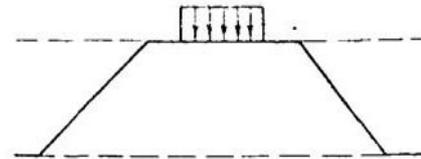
Расчет напряжений в грунтах насыпи по схеме упругого полупространства
